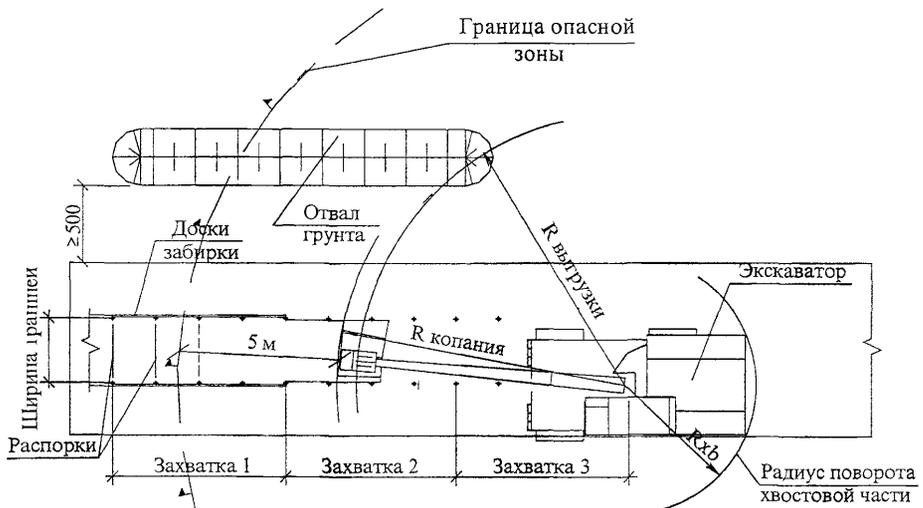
Схема производства работ по разработке грунта траншеи экскаватором и устройстве заборки
